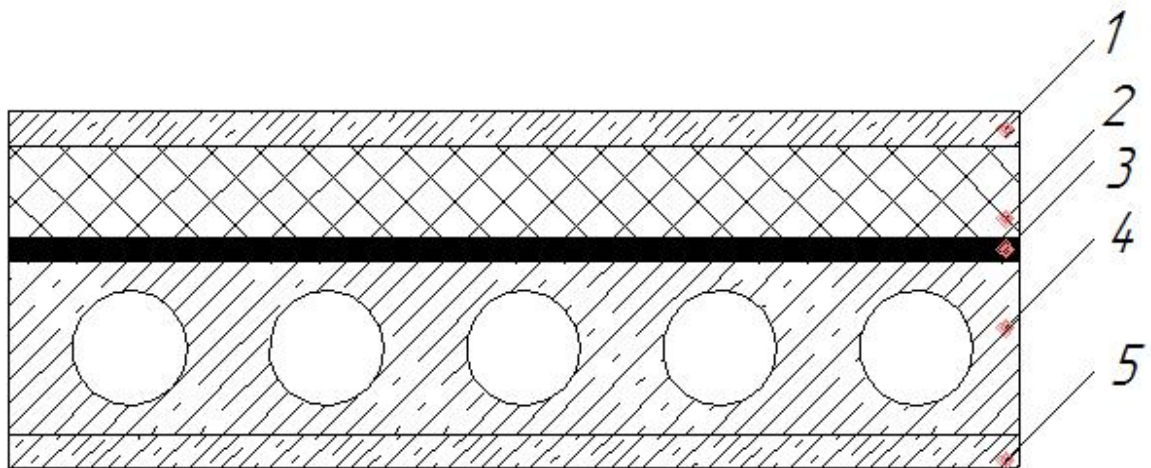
Схема конструкції горищного перекриття: 1 – стяжка;
